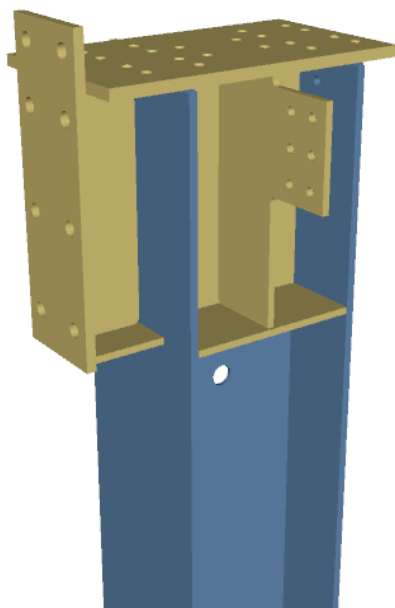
Chapa de topo e chapa corte soldadas em pilar
